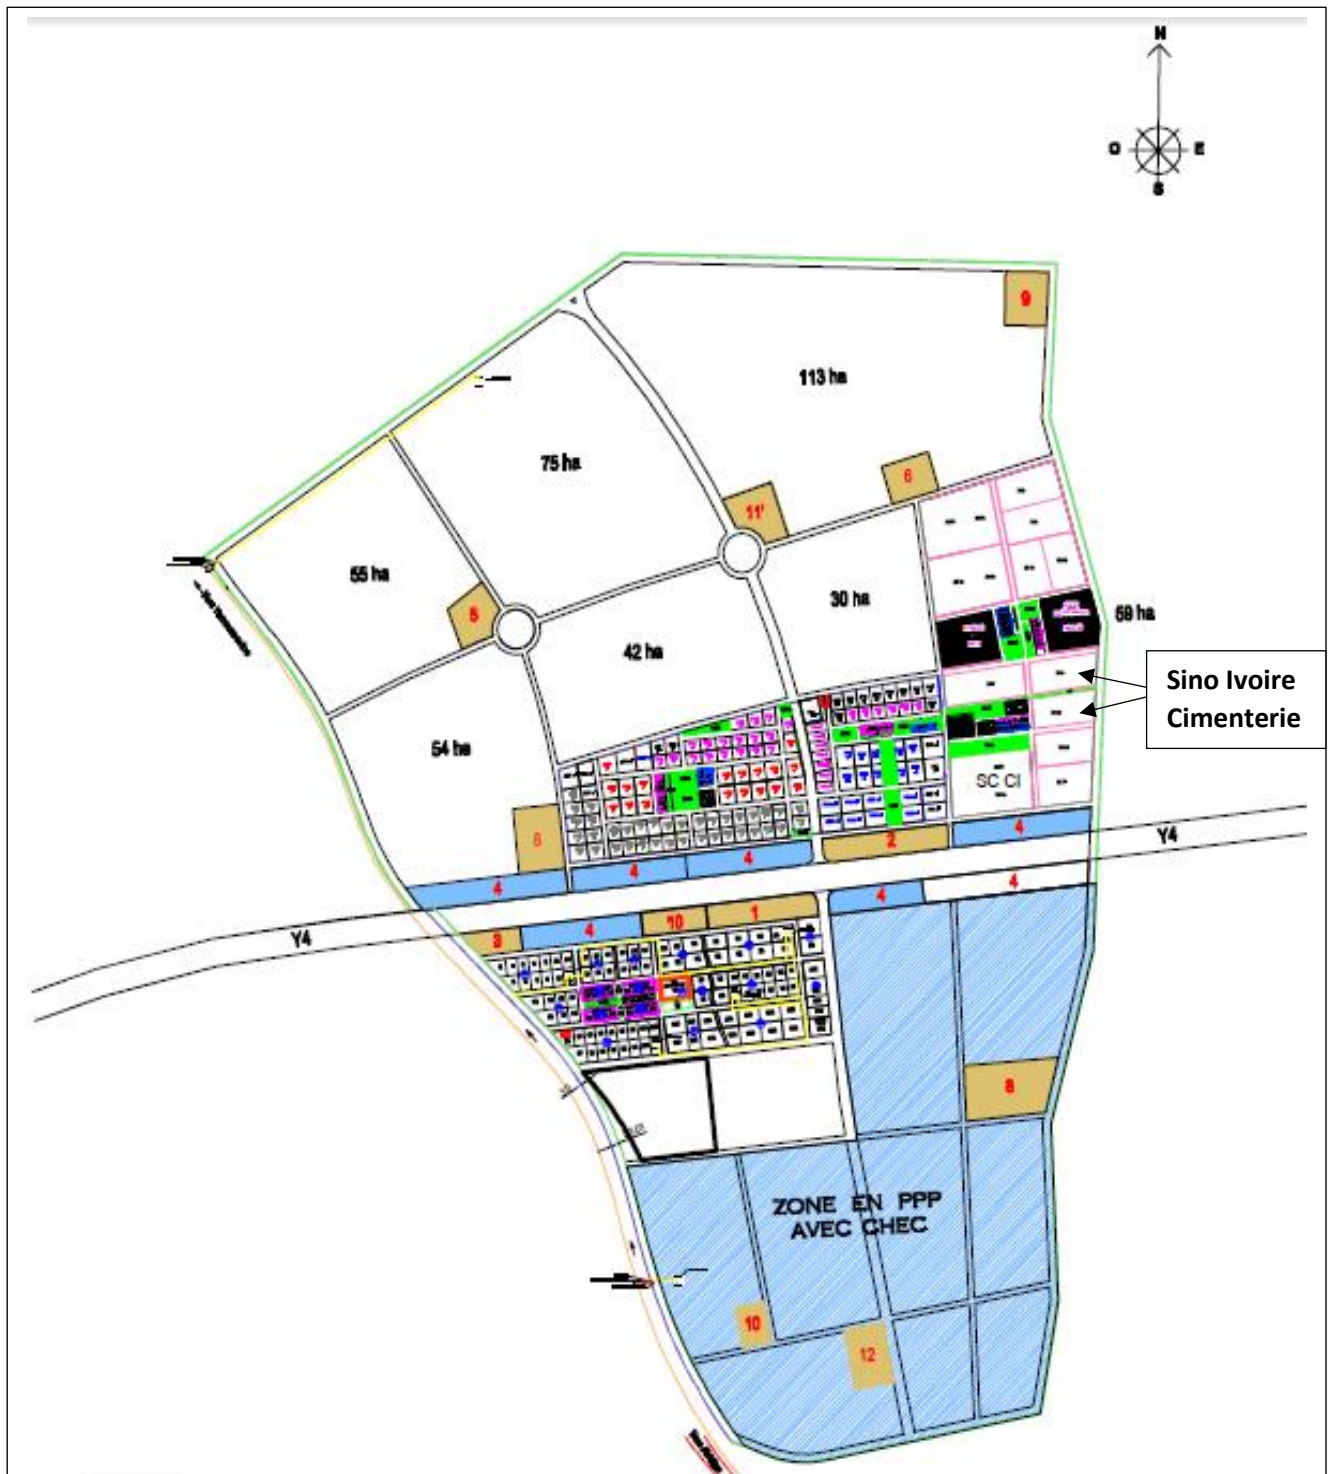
Identification du site de SINO IVOIRE CIMENTERIE sur le plan de morcellement de la zone industrielle de PK 24
